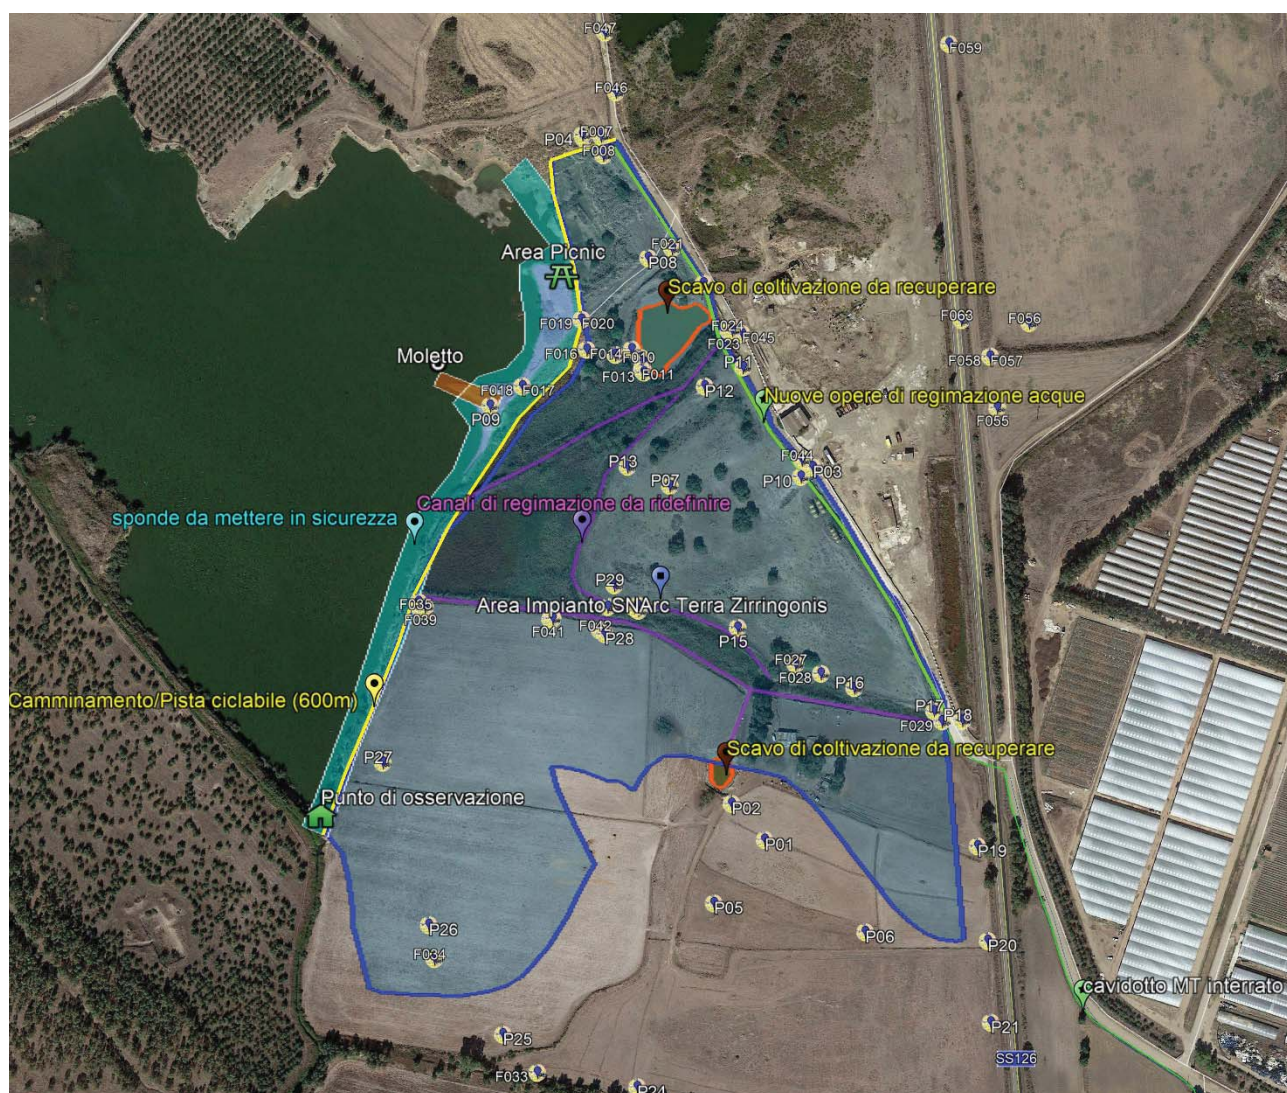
Planimetria del piano di recupero dell'area di cava su Google earth
